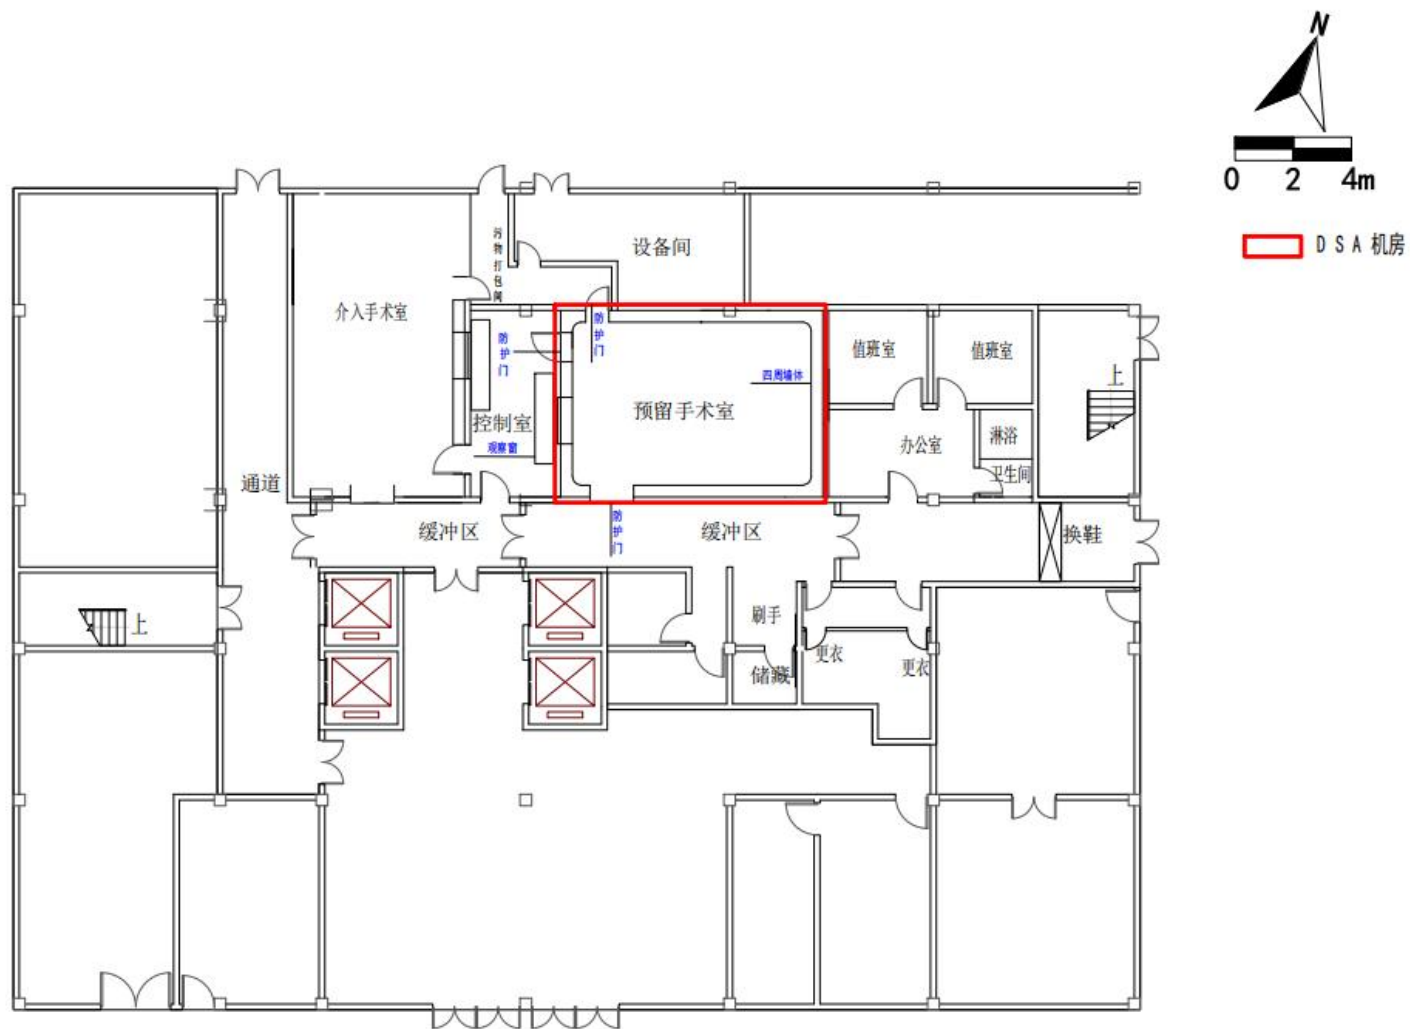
原预留手术室平面布置图 (3 号楼一层)
